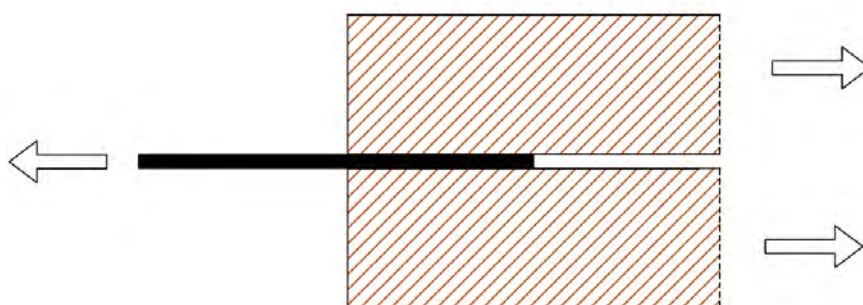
Ligação aço-madeira com chapa metálica central
